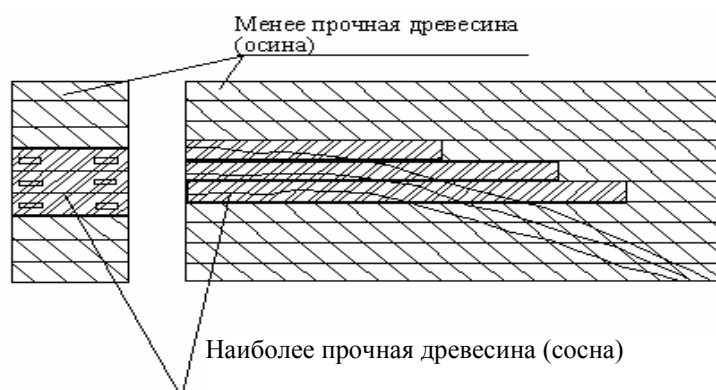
Схема комплектования клееной конструкции и способ ее усиления армированием
